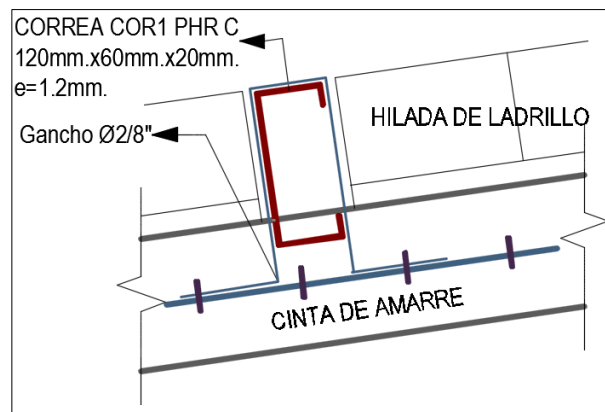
Detalle unión perlin apoyado en cinta de amarre.
